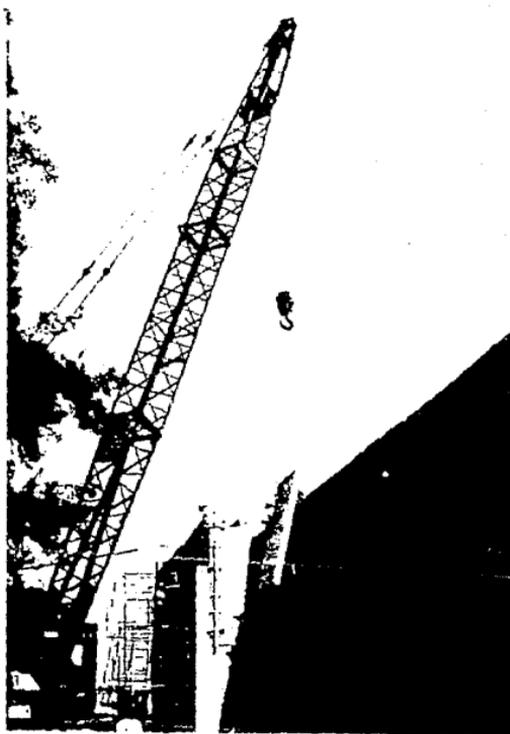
MONTAJE DE LOSAS TT EN FACHADA
